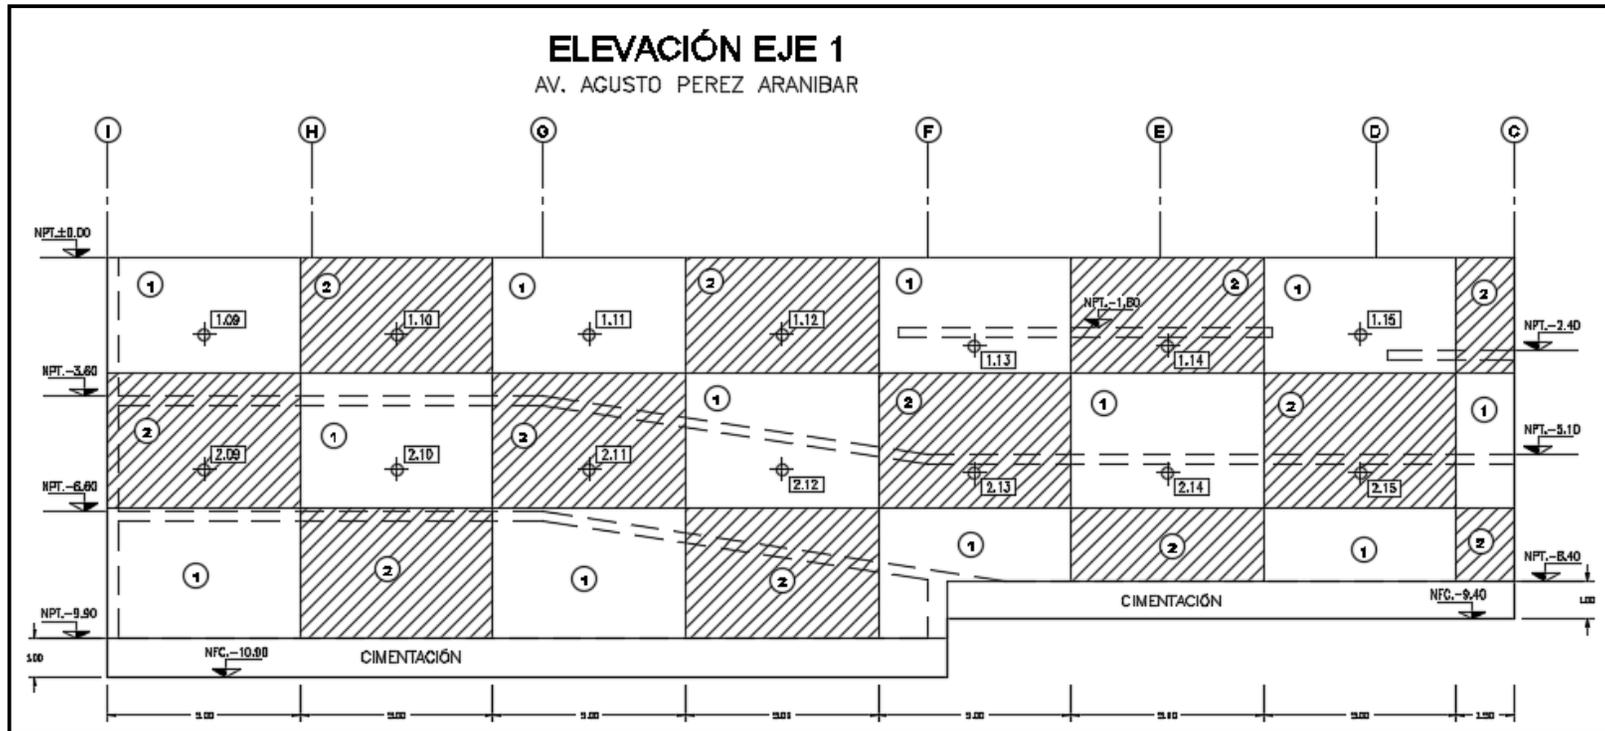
Elevación Eje 1 obra 2: Edificio Crossland – Muro anclado.
